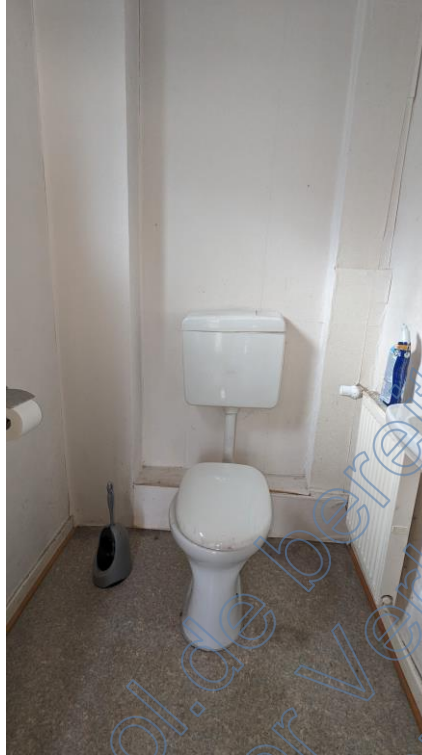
WC im Erdgeschoss, außerhalb der Wohnung, nur über Treppenhaus
